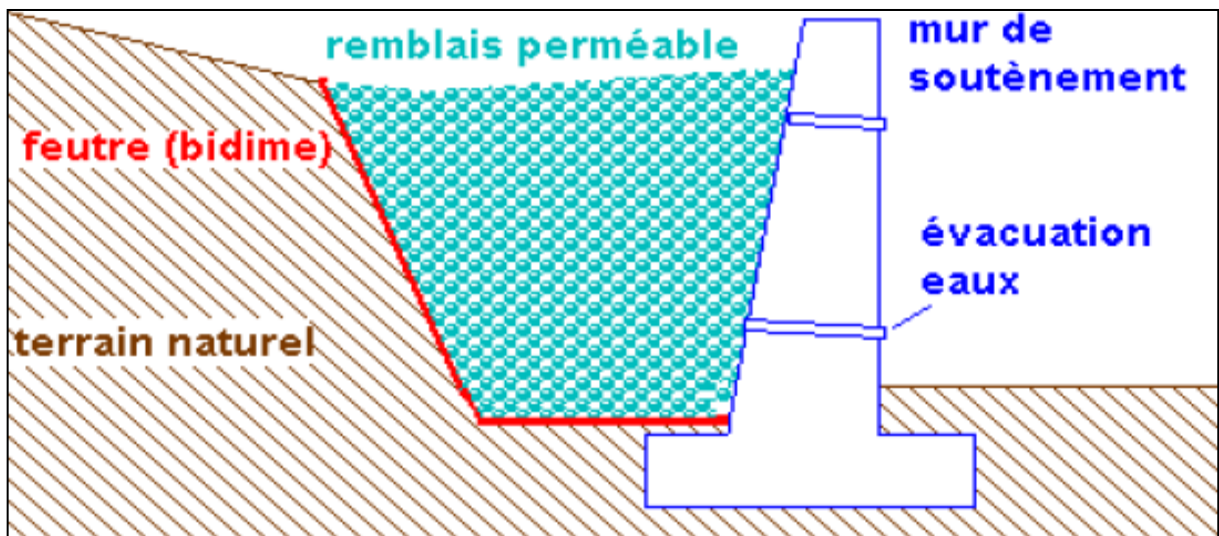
détail murs de soutènement. Source: <http://www.iddemaison.com/gros-travaux/pose-d-un-mur-de-parpaing/le-murs-de-soutènement.html>
